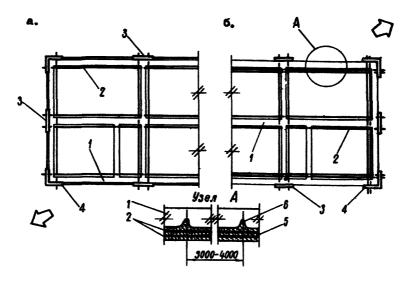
Схемы устройства фундаментных поясов с помощью предварательно напряженных стальных тяжей:
